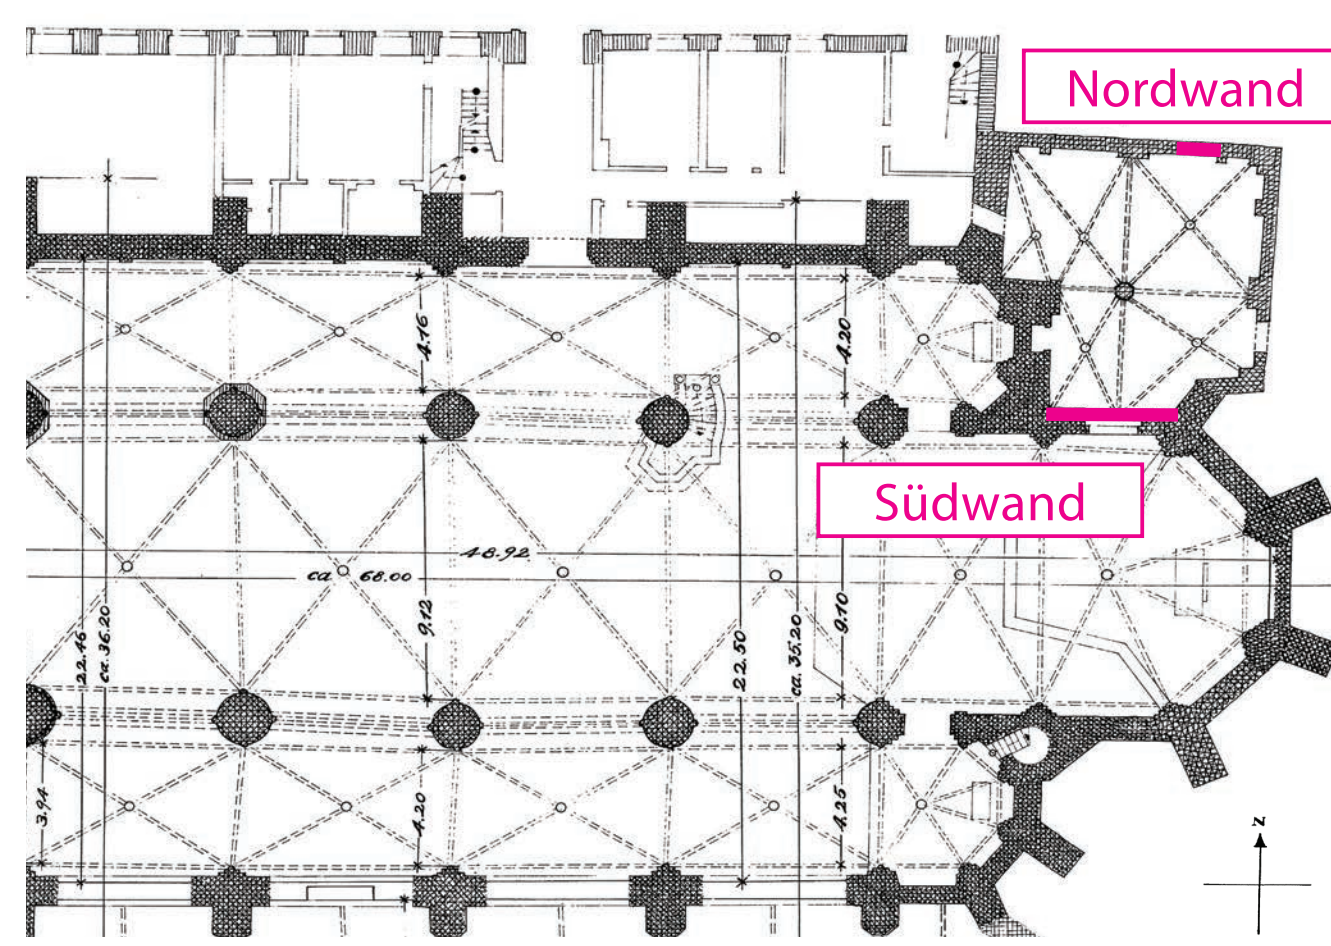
Ausschnitt Grundriss des Ostteils der St. Jacobi Kirche mit Anbau (Erdgeschoss). Eingezeichnete Position der Wände äquivalent zum Obergeschoss. Quelle: Archiv Denkmalschutzamt Hamburg.
